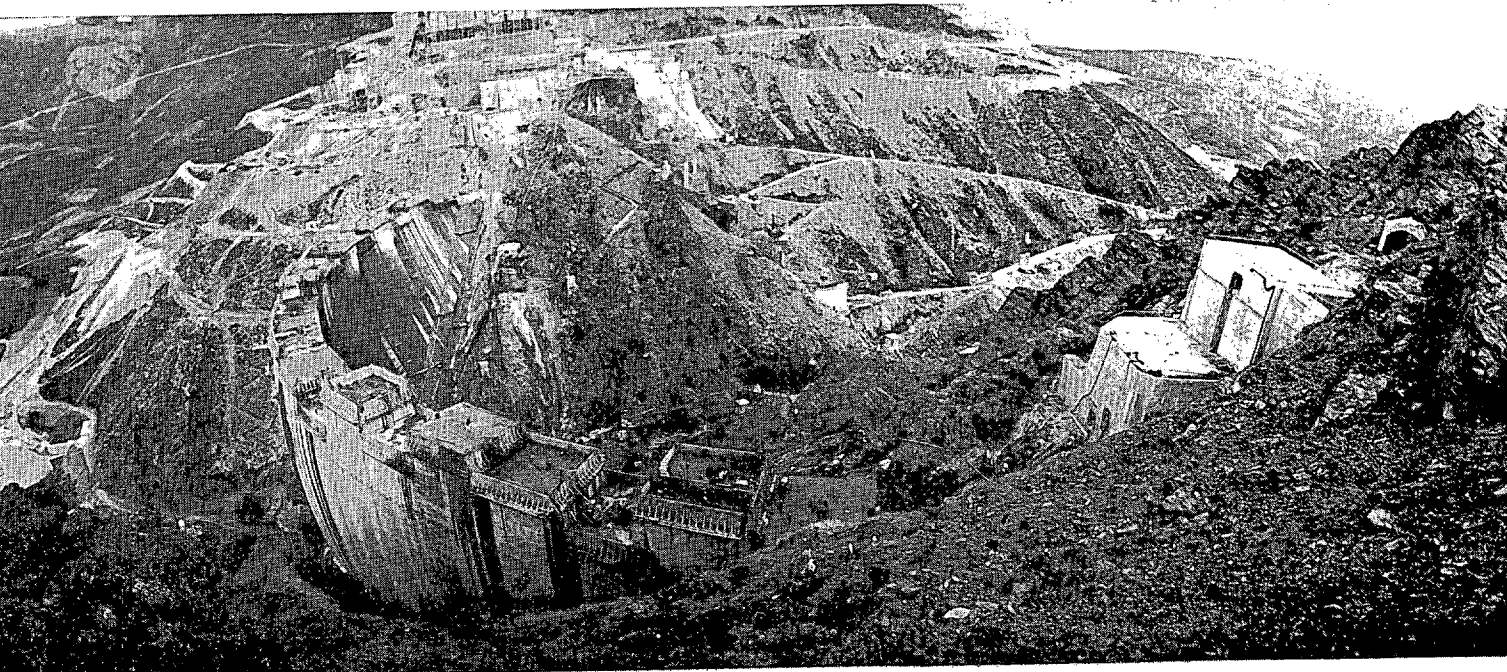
Hormigonado de un bloque de la presa de Las Portas (marzo 1973).
